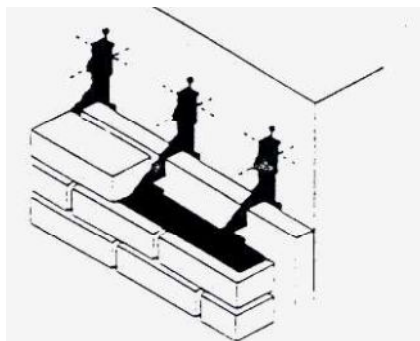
Exemplo de um sistema de apoio da alvenaria [5]
